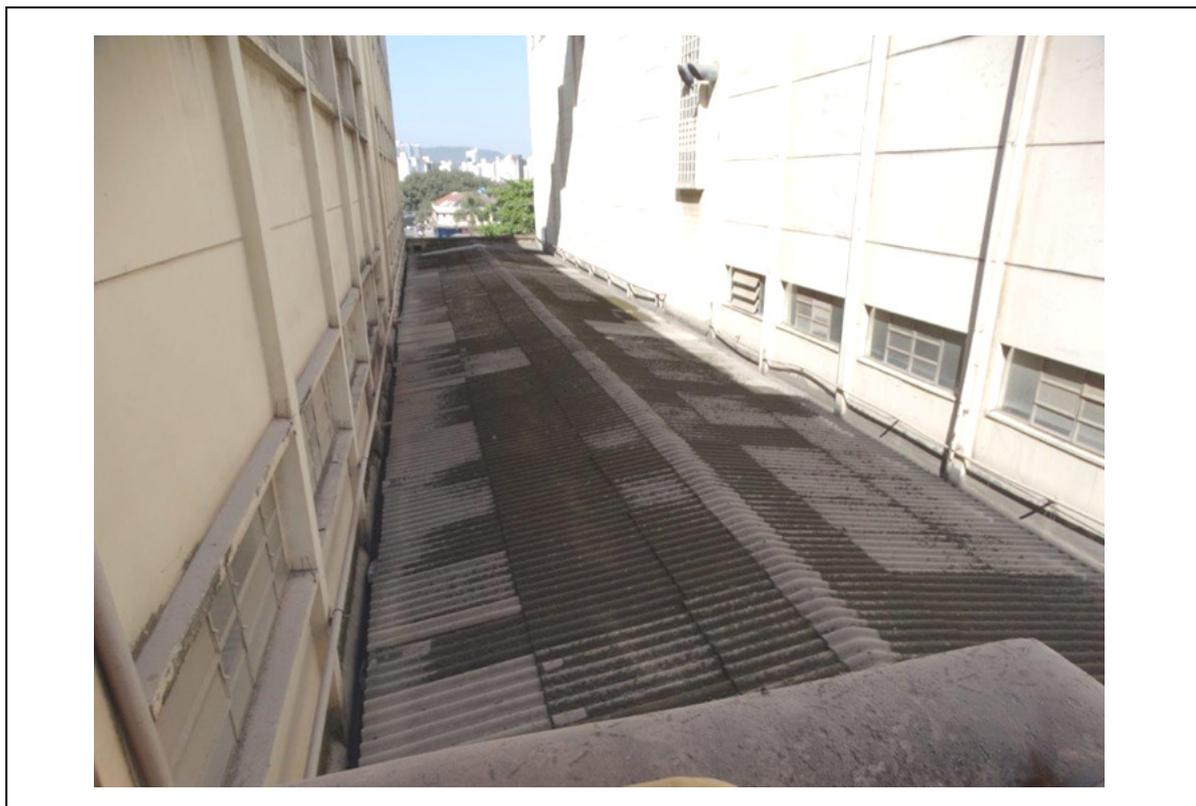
TELHADO ENTRE H0 e H1/H2.
